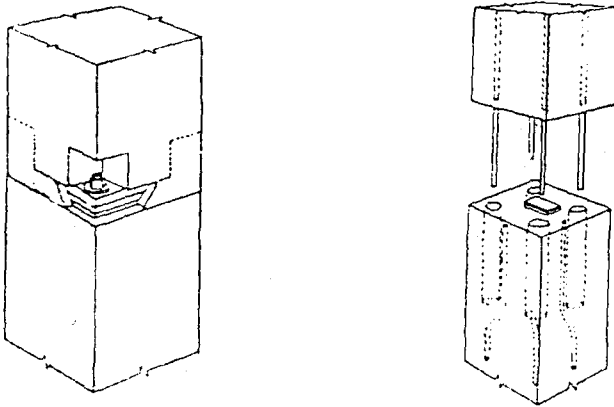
Temelde bırakılan filizlere kolon donatıları kaynaklanarak kalan boşluklar betonlanır.[17]
